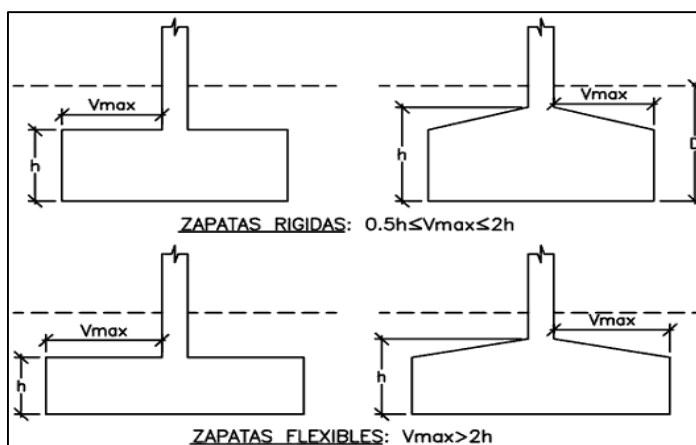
Formas Típicas de Zapatas Aisladas.
